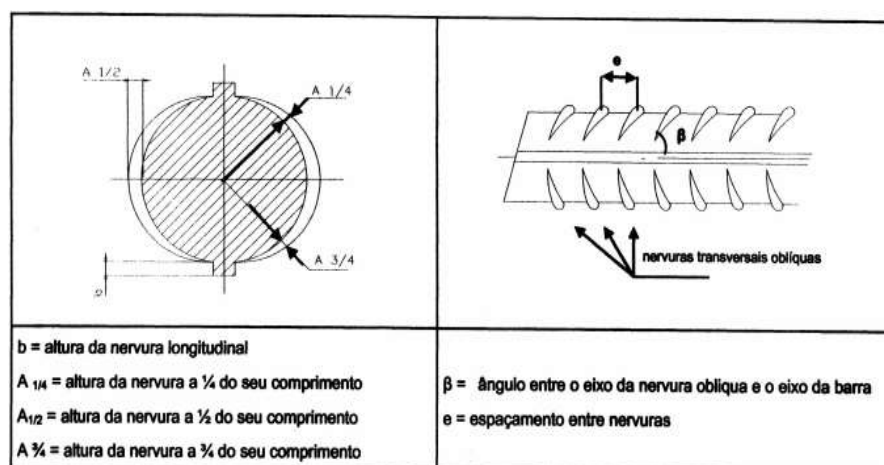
Configuração geométrica das nervuras transversais, oblíquas e longitudinais.
